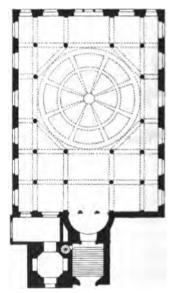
St. Stephans church, Walbrook, zu London. Grundriss.
